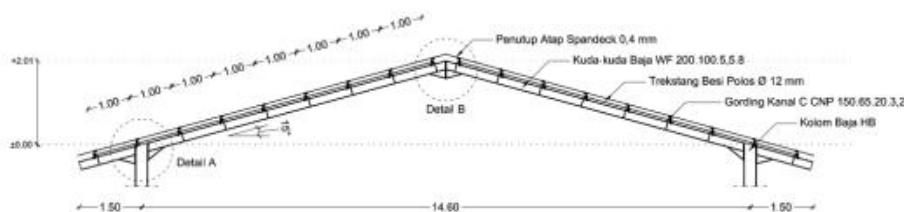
Denah Kuda-Kuda Type 1 & Type 5
